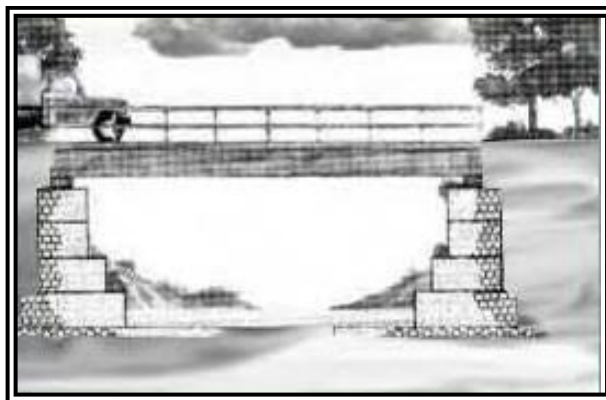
Puente de vigas simplemente apoyadas (isostático) un tramo.
